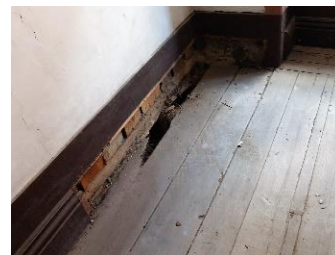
pavimento e rodapé de madeira com um grau de degradação avançado
